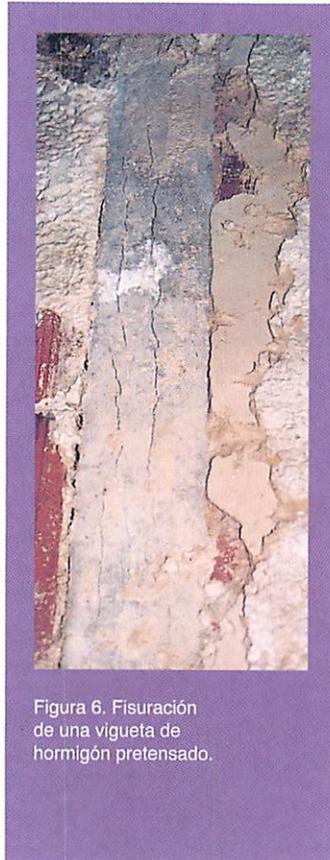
Fisuración de una vigueta de hormigón pretensado.
